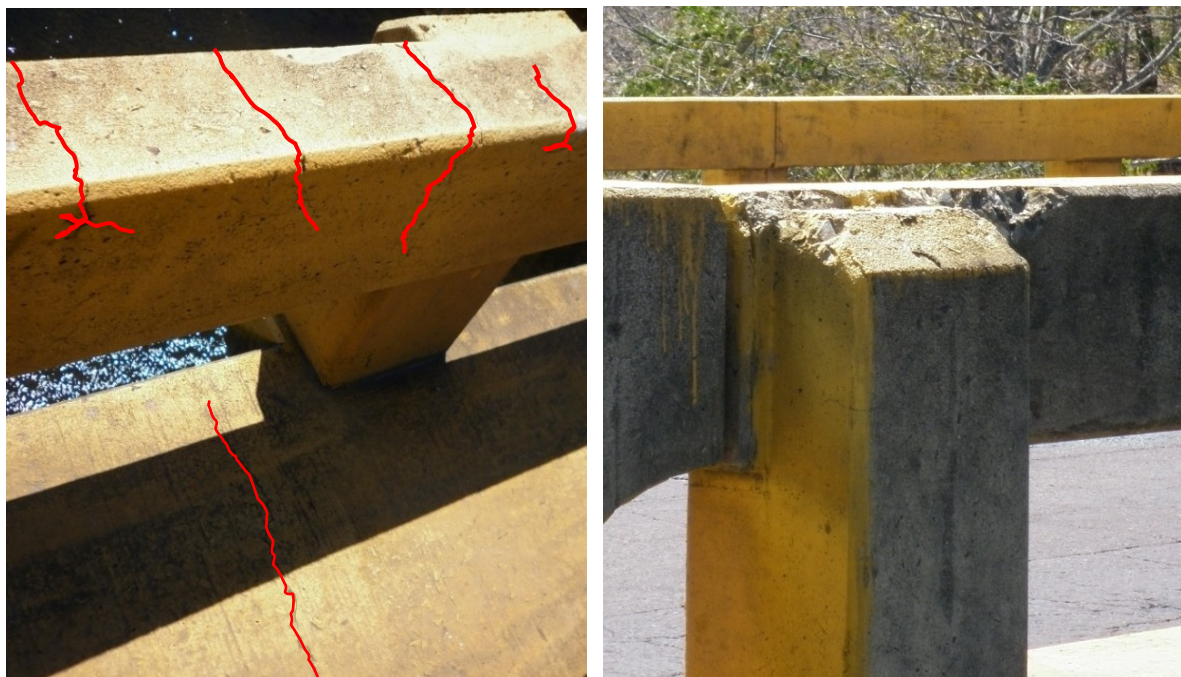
Grietas y desprendimientos de concreto en la barrera vehicular.
